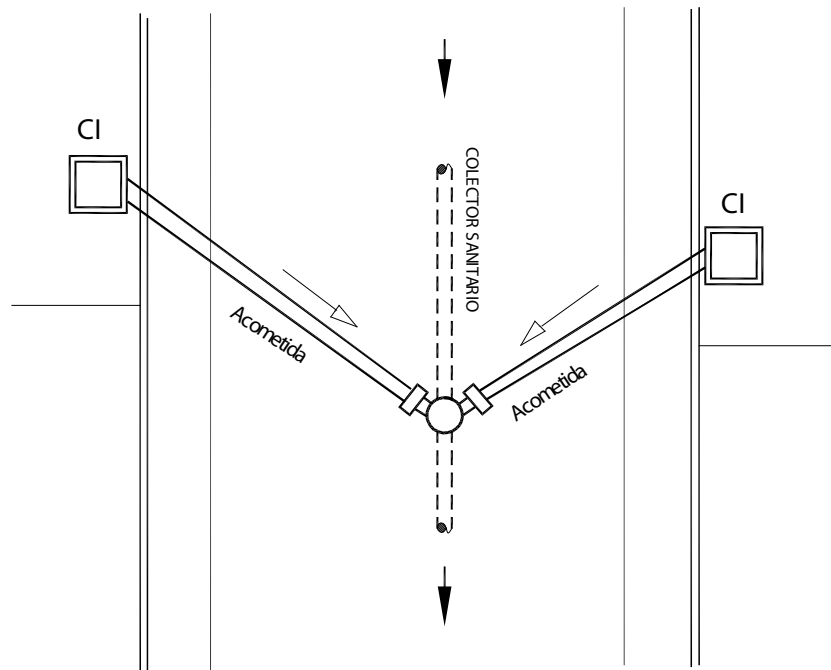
Sistema radial - conexiones simples. Alternativa “A”
